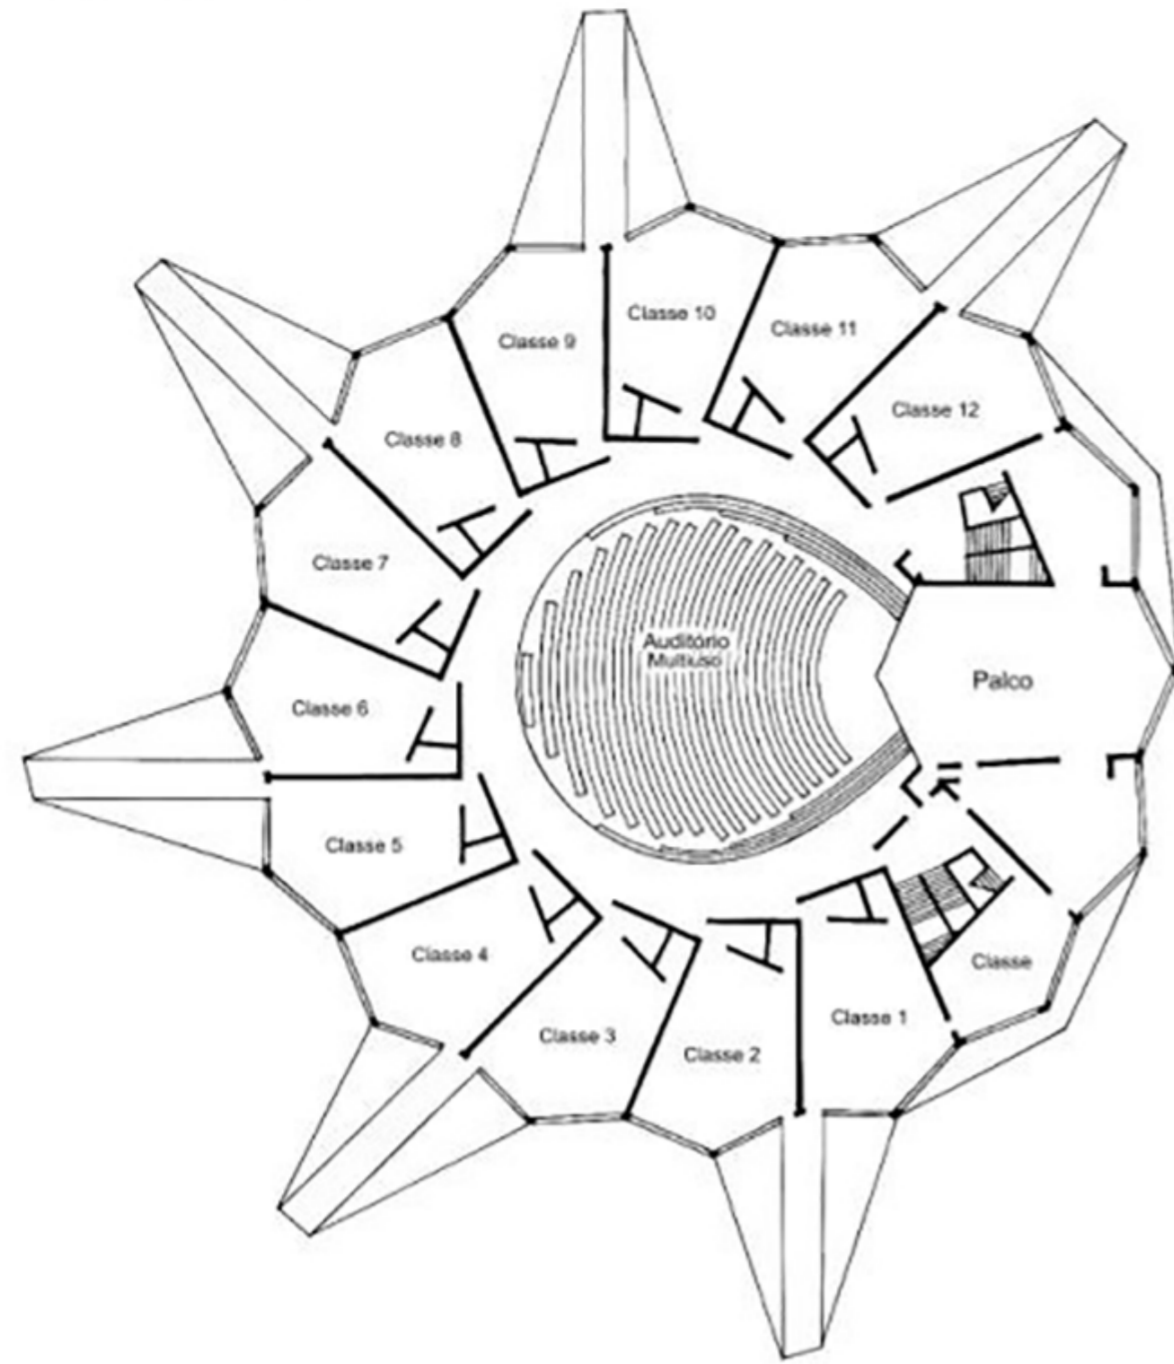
Planta baixa do auditório e salas de escola Waldorf, Toronto
